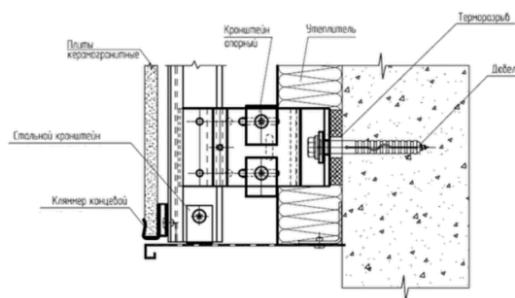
Узел монтажа керамогранита в вентилируемом фасаде с открытым стыком
